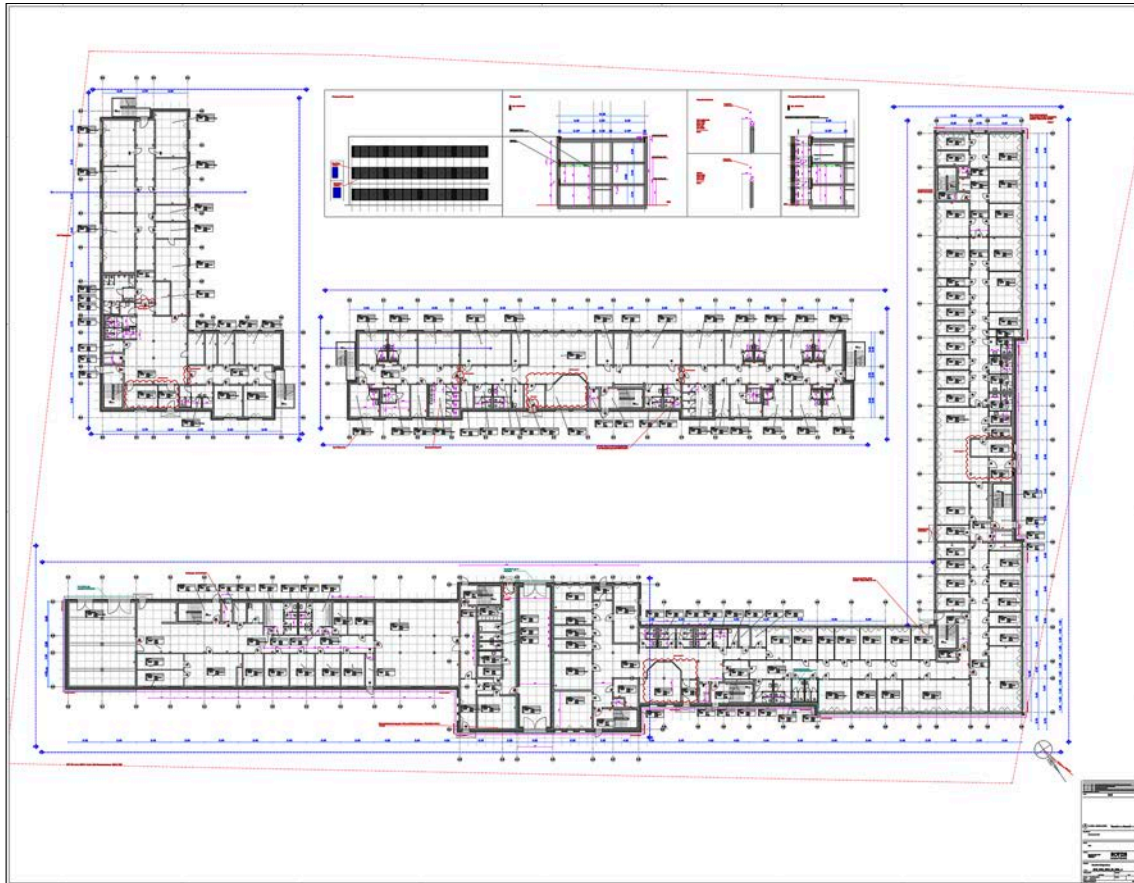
Grundriss Erdgeschoss Behördenzentrum (Quelle: Bauatelier Rotor GmbH, Berlin, Stand: 26.01.2024)
